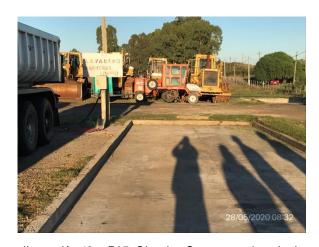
P05. Obrador. Sector para lavado de camiones con pendientes hacia sistema de decantación.
